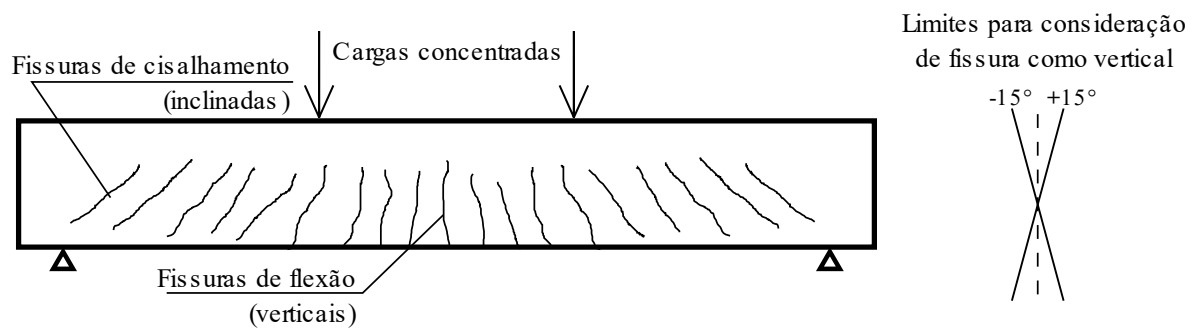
Fissuras típicas em uma viga e limite angular para consideração de fissura vertical do modelo implementado.
